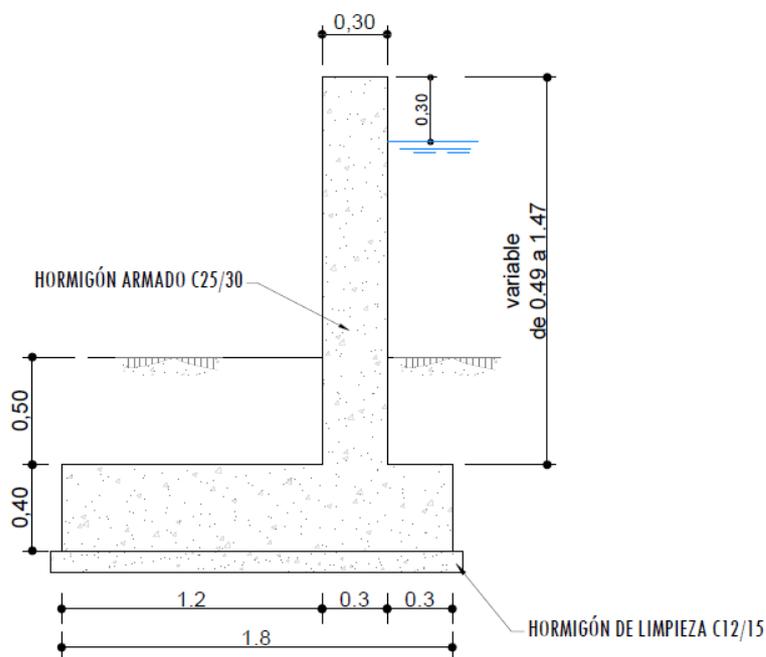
Muro de protección de la EDAR de Vera. Sección tipo
